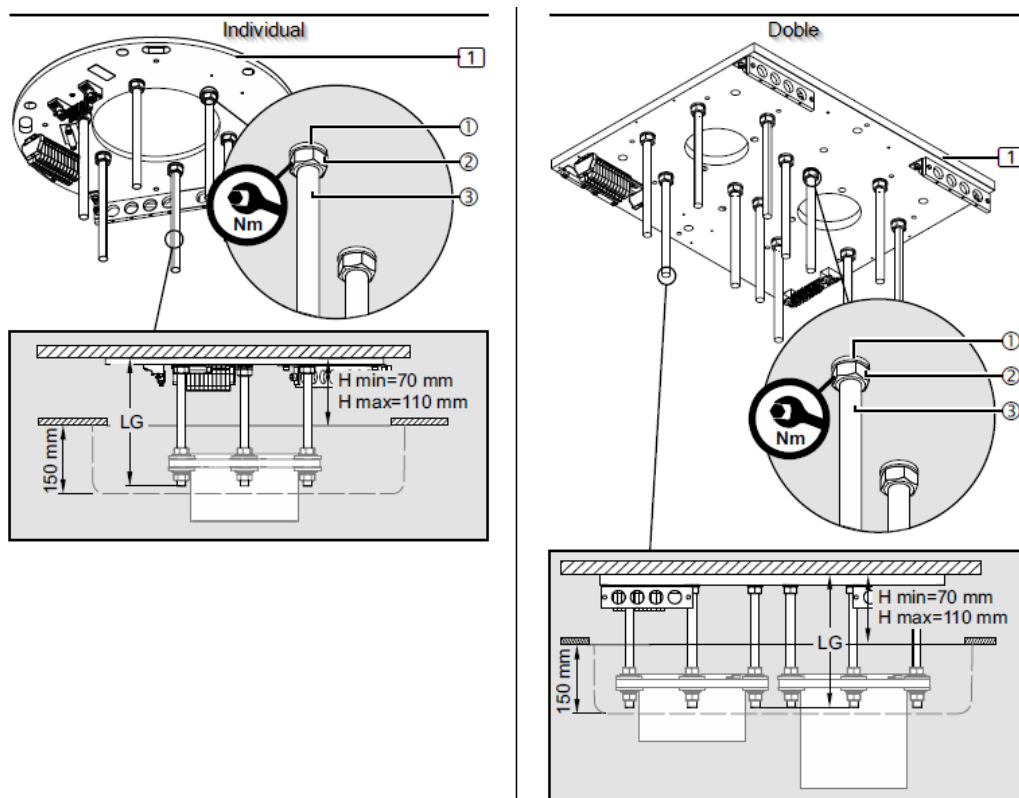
Installation de la plaque d'interface avec le faux plafond
